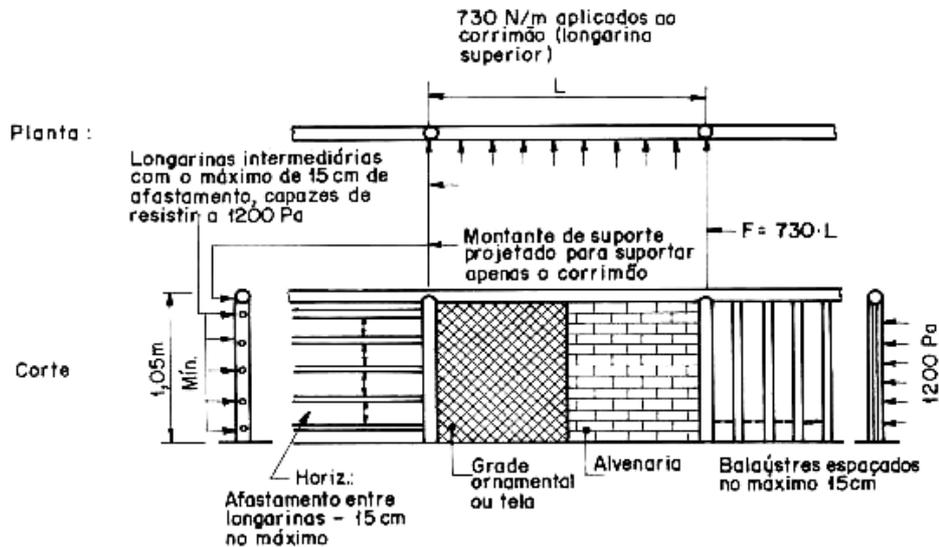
Pormenores construtivos de instalação de guardas e cargas a que elas devem resistir
